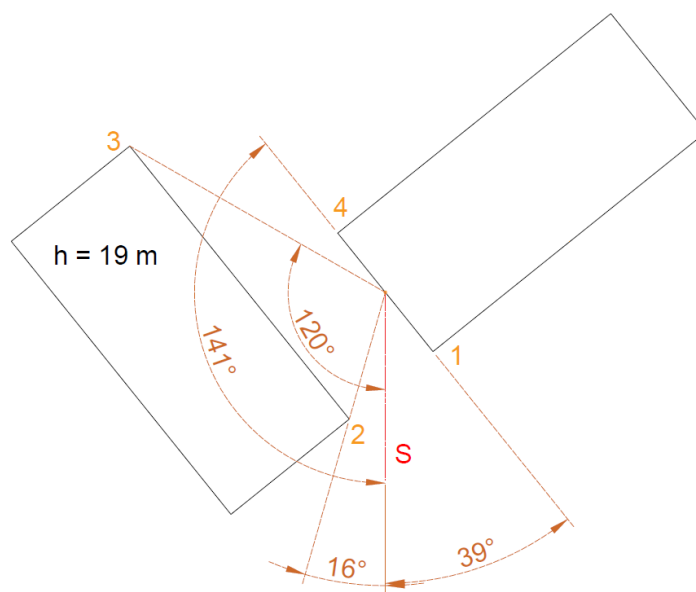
Esquema para el cálculo de sombras en la fachada suroeste.
